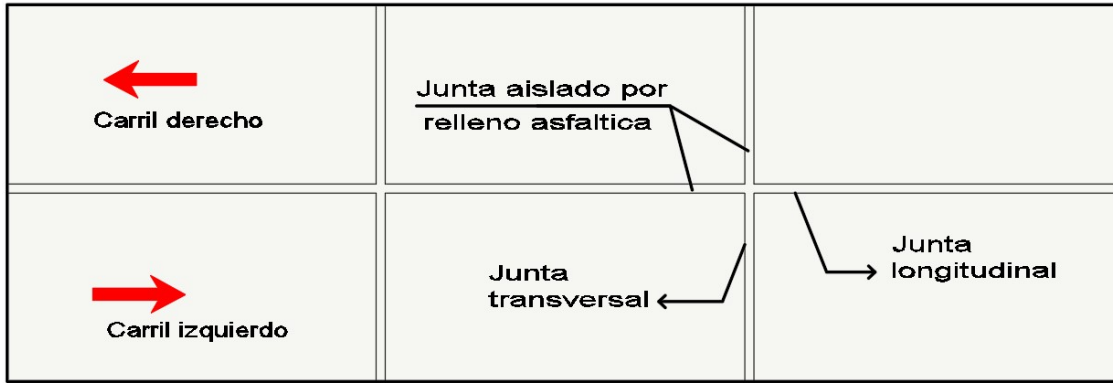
Pavimento de junta aislante sin transferencia de carga.
